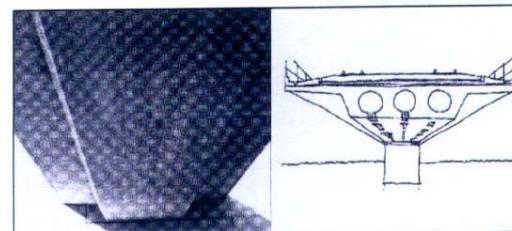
Defectos de ejecución en un puente losa por acumulación de barro y suciedad bajo los aligeramientos, que han impedido un correcto hormigonado. La importancia de conocer su pequeña historia
